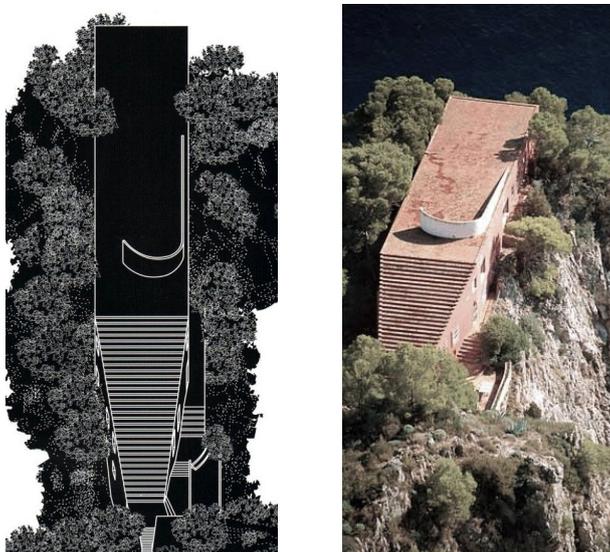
e 47. Casa Malaparte em Capri, Grécia
